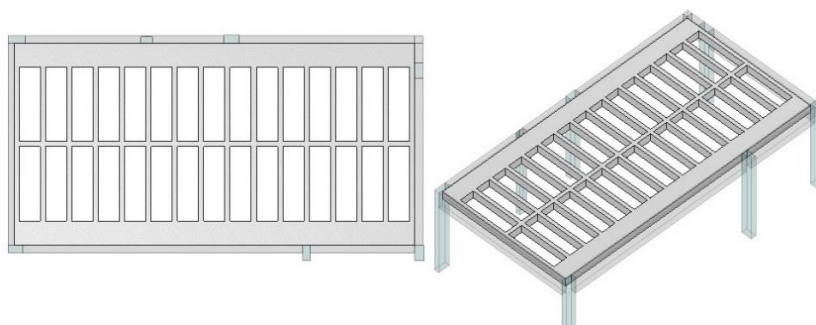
Laje L8 nervurada unidirecional em planta e em perspectiva. (Fonte: AUTORIA PRÓPRIA; 2023)
